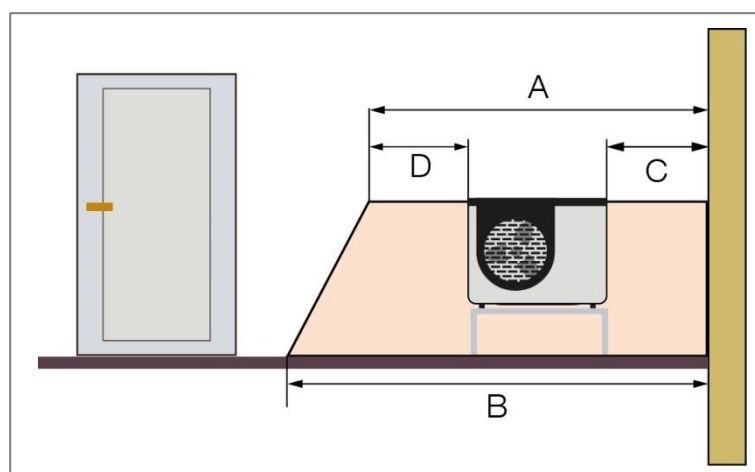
Installation à l'angle d'un bâtiment à droite, également valable en miroir avec l'angle du bâtiment à gauche.
